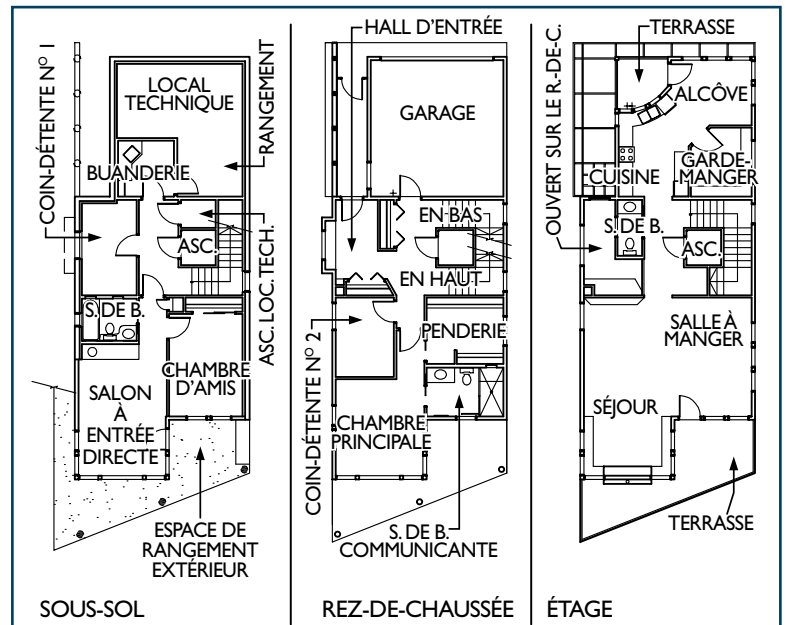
Plans du sous-sol, du rez-de-chaussée et de l'étage d'une habitation adaptable
